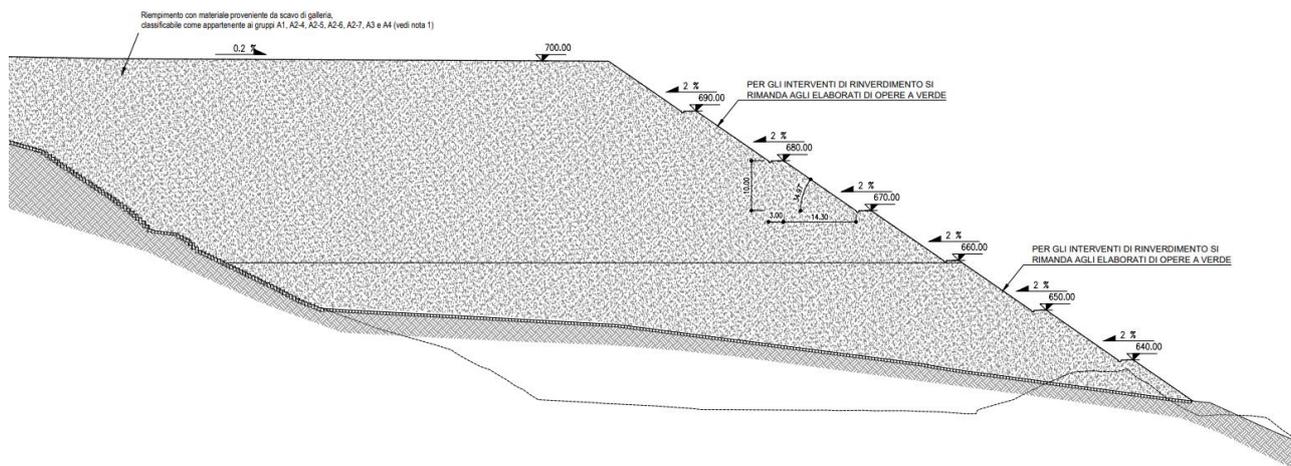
Sezione tipica di progetto dell'abbancamento
